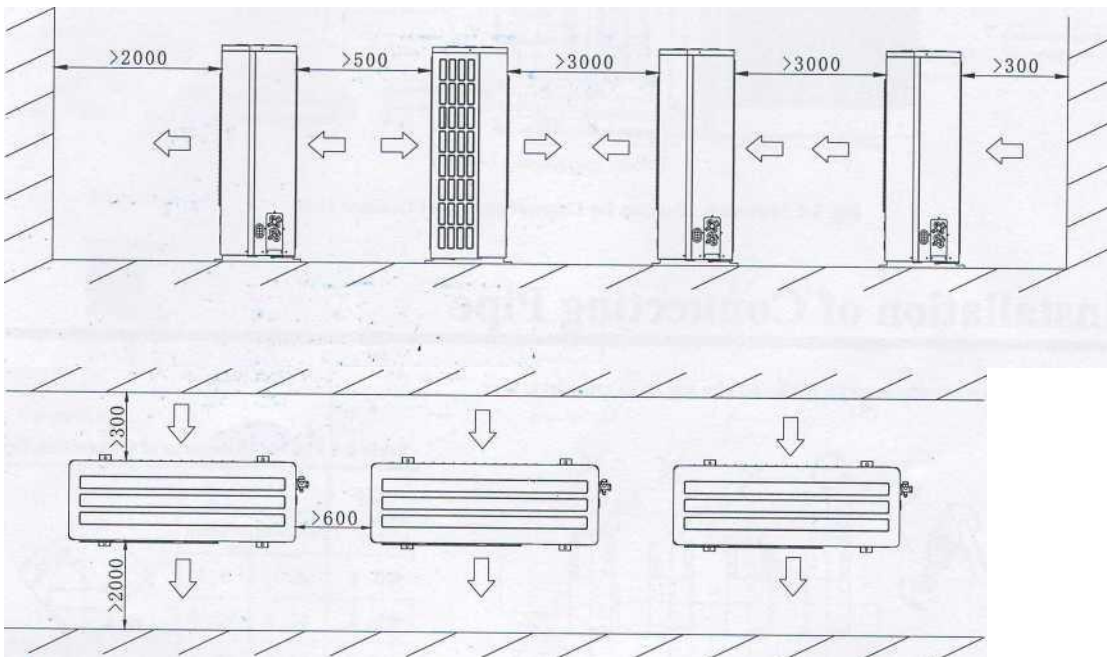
Схематический эскиз II для установки и обслуживания наружного блока
